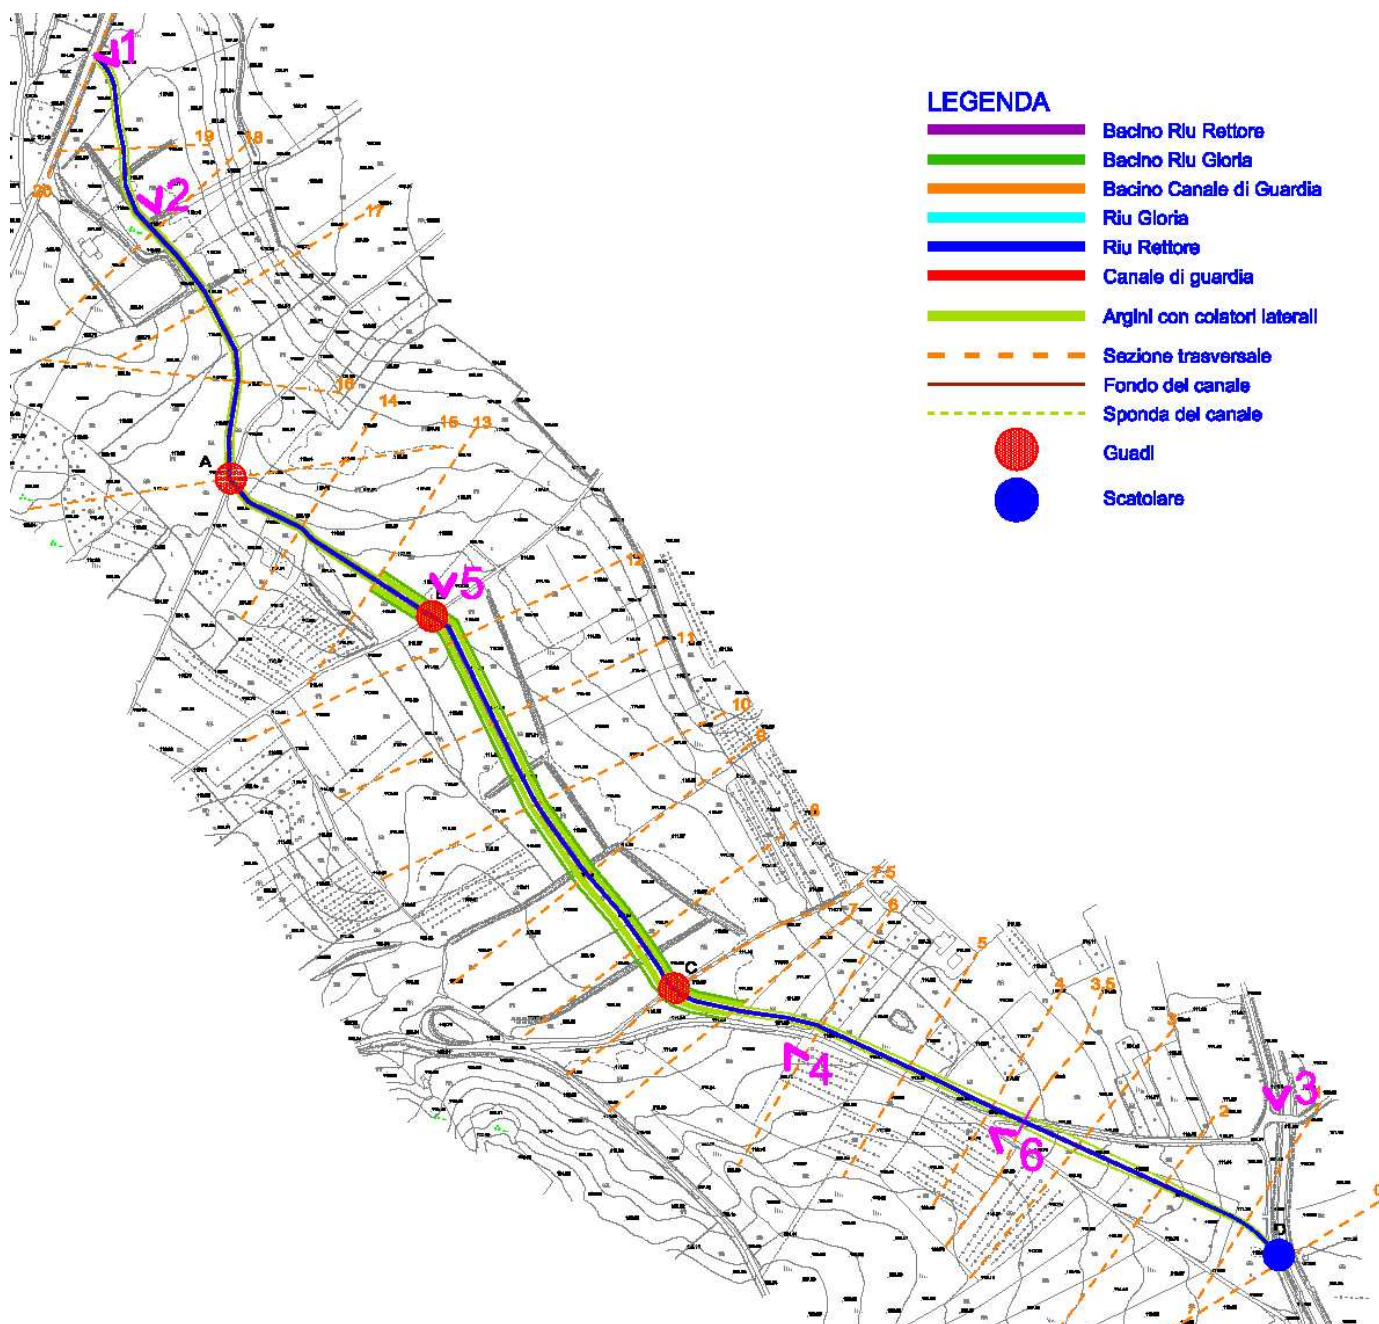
Planimetria del canale diversivo con viste fotografiche
